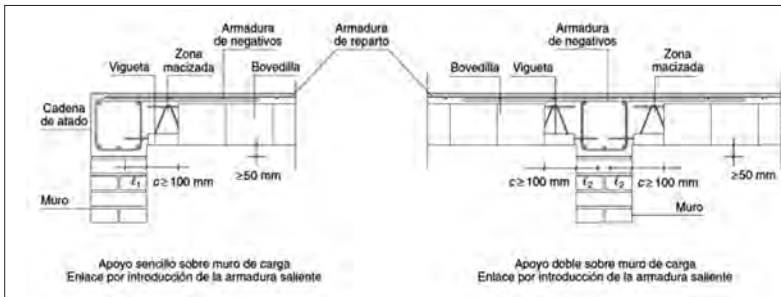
y 22: apoyo sobre muro de carga. Enlace por introducción de la armadura saliente.
